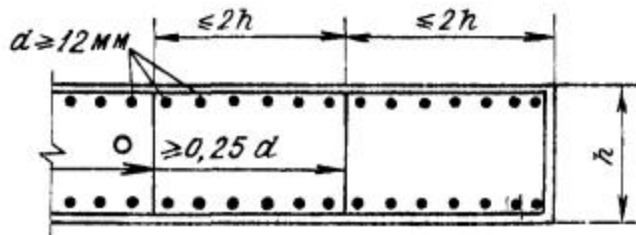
Конструкция поперечных связей в массивных внецентренно сжатых элементах, рассчитываемых без учета сжатой арматуры
